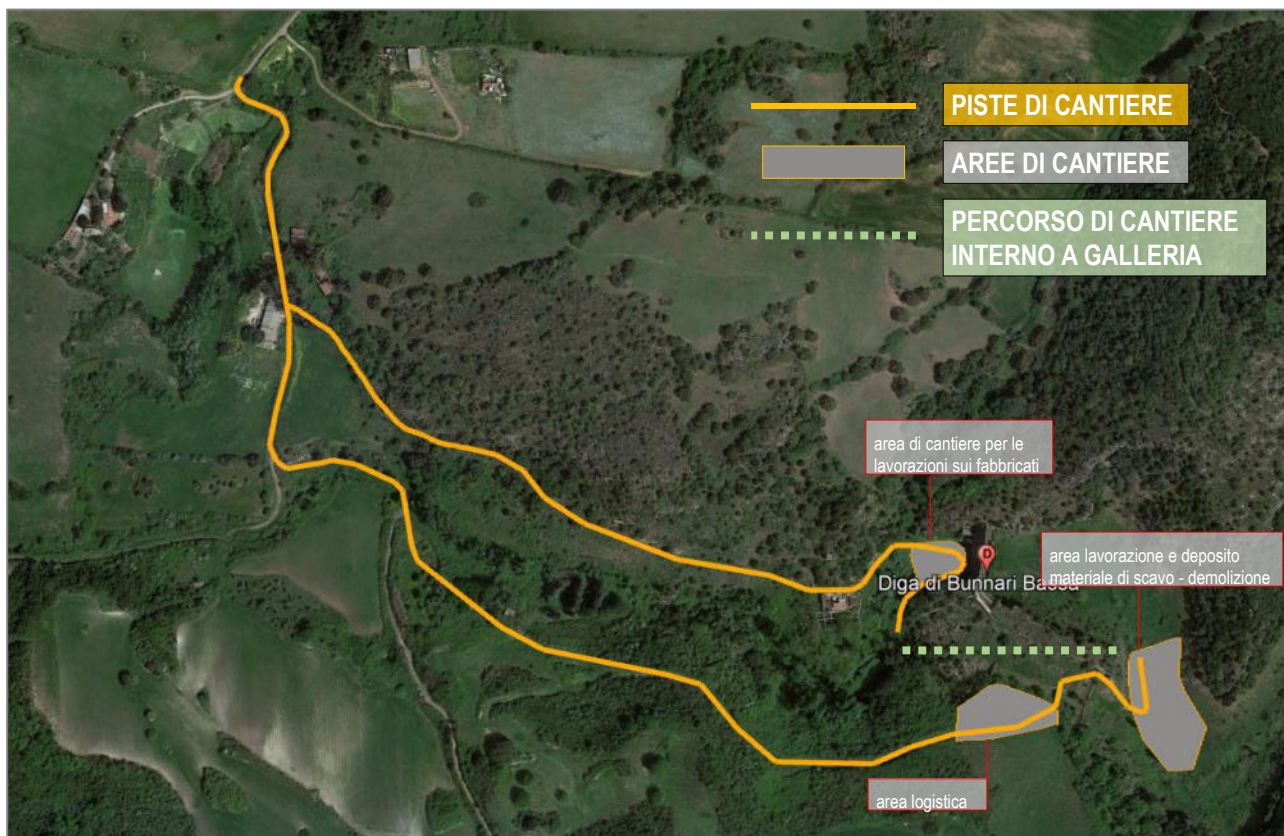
Stralcio planimetrico con indicazione degli apprestamenti di cantiere
